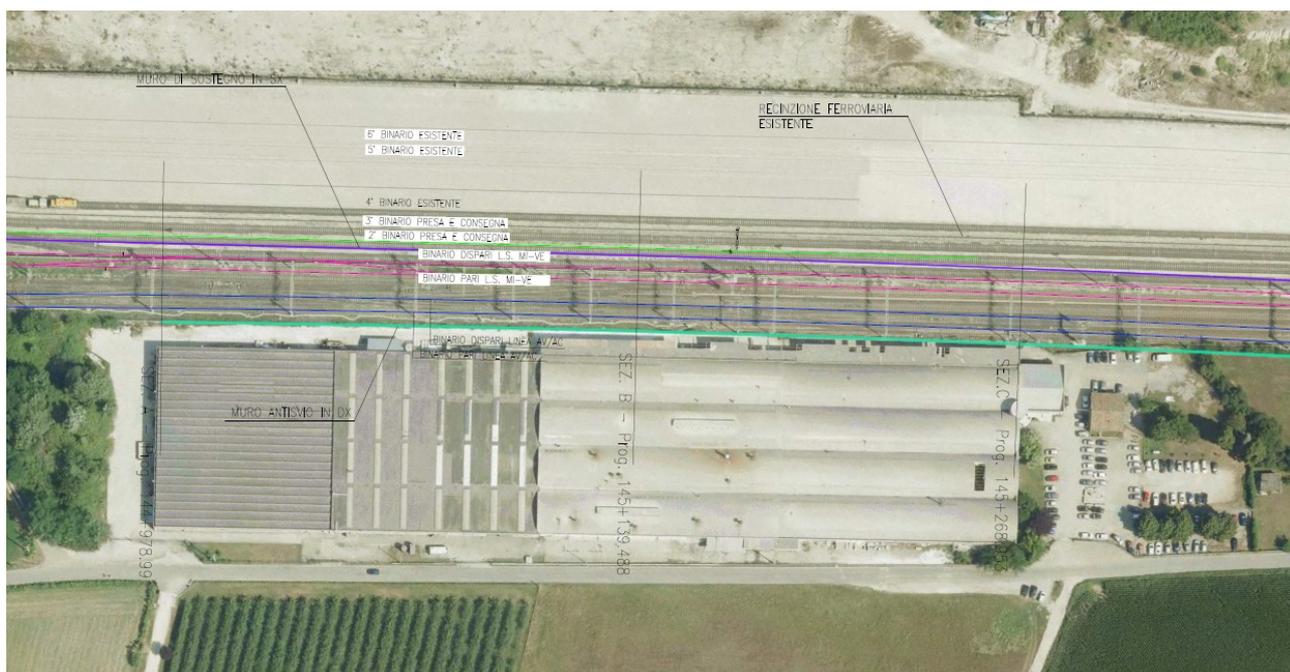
Posizione in pianta dell'edificio ANCAP e della linea di trazione AV
